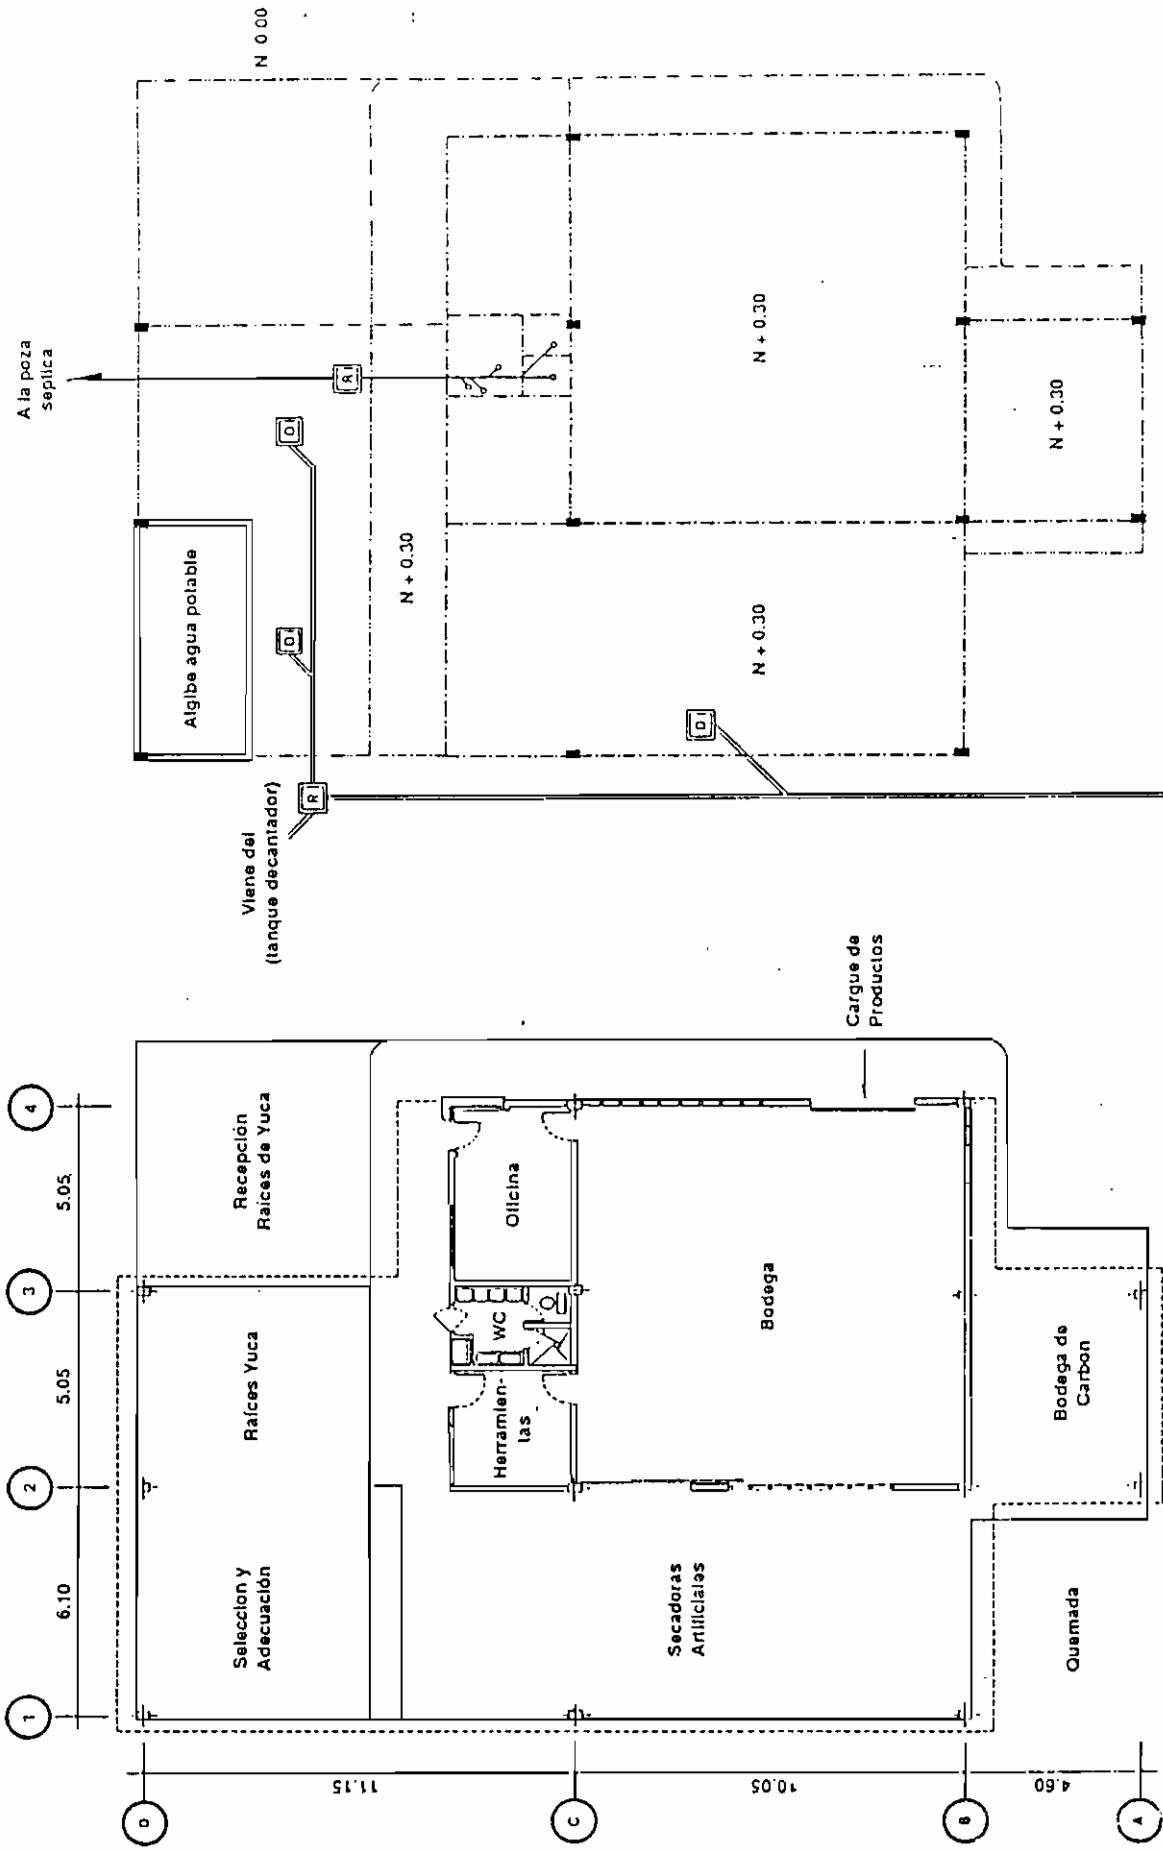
PLANTA GENERAL Y EJES DE COLUMNAS
